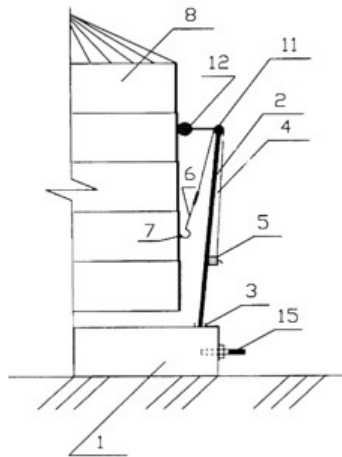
Влаштування додаткової розпірки на анкері у фундаменті / Placing additional spacers at anchor in the basement:
